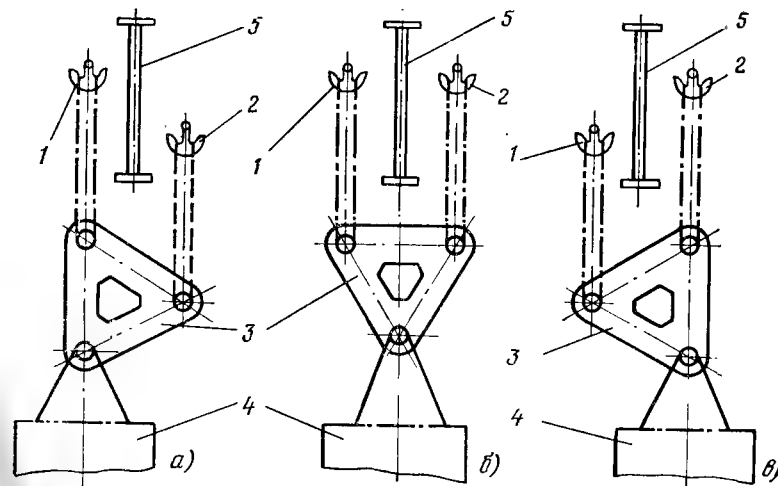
Схема передачи блоков котла под балками потолочного перекрытия при помощи рамы-треугольника.
